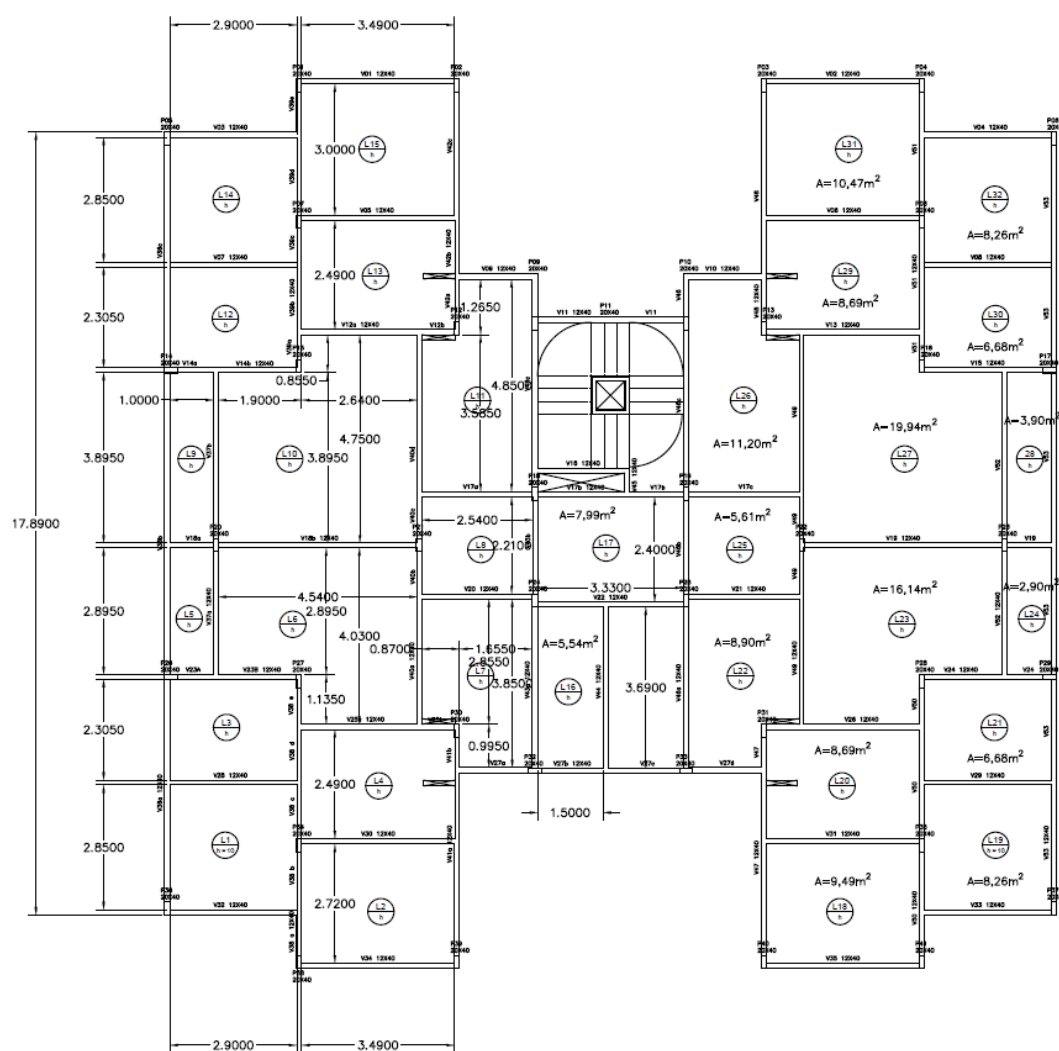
LANÇAMENTO ESTRUTURAL - PAVIMENTO TIPO
